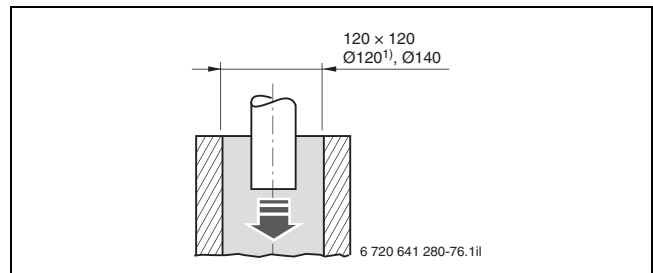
Mindestmaße des Schachtquerschnitts für die Montage der Abgasleitung (Maße in mm)
